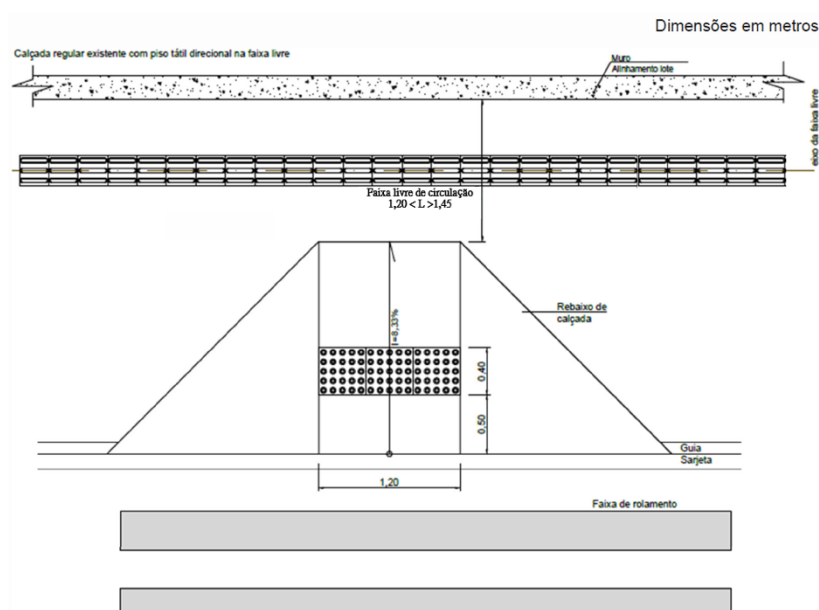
Rebaixo dos passeios para travessia de pedestres para largura de 2,00m
